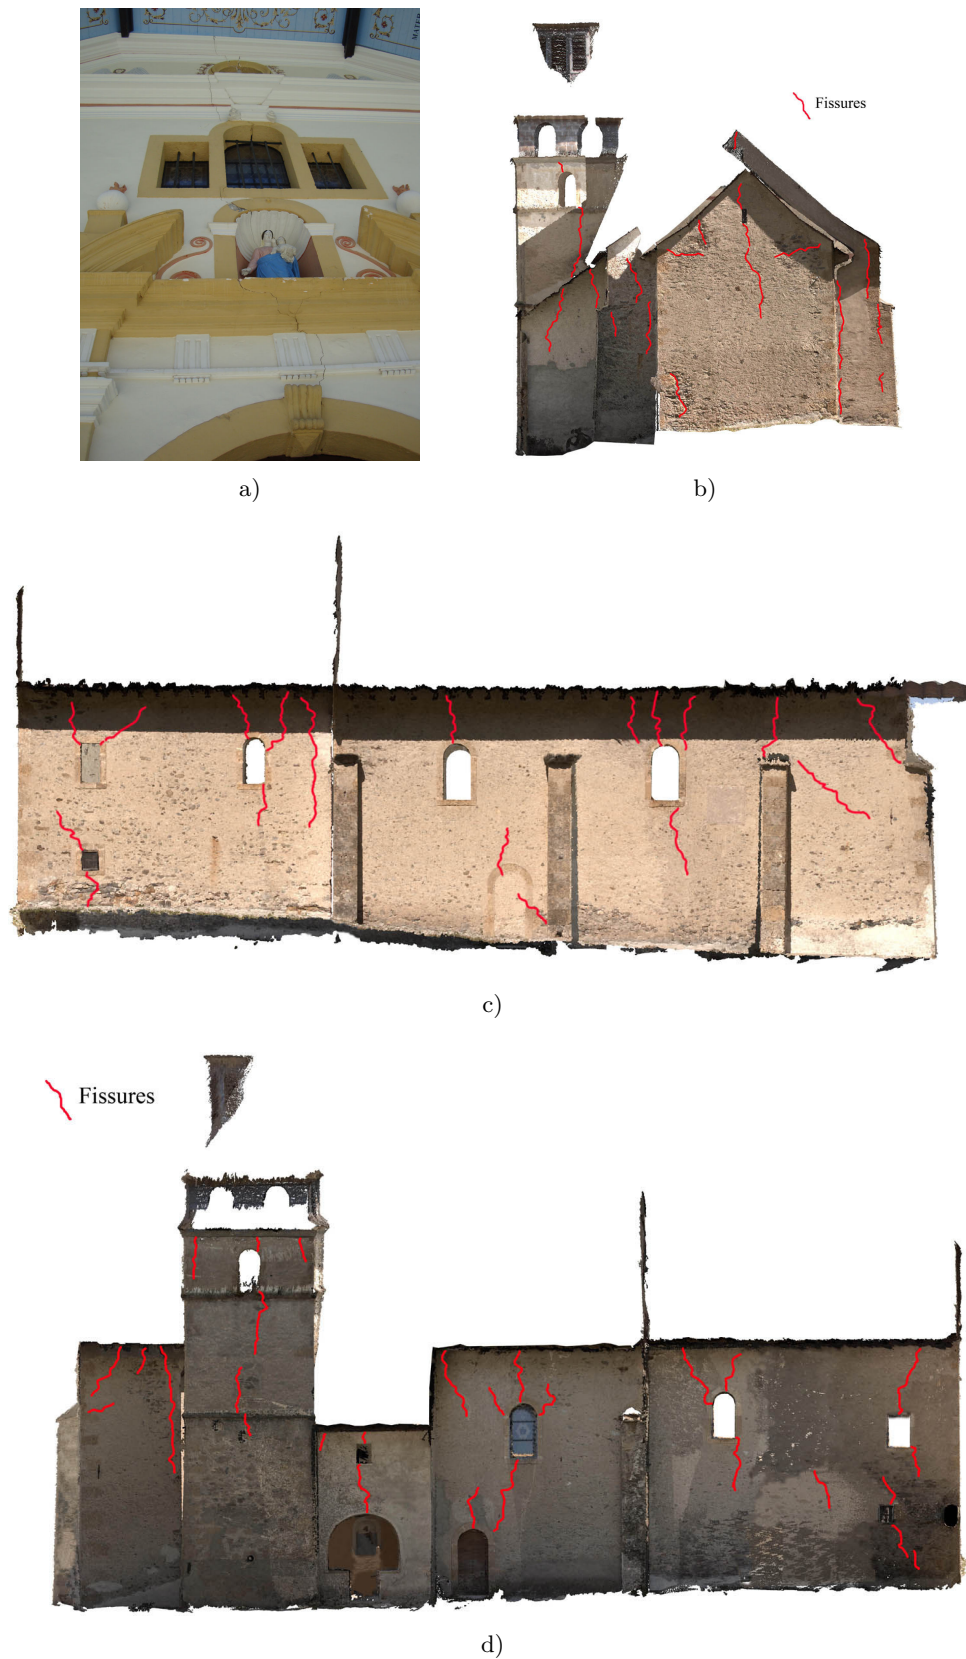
Relevé photogrammétrique des fissures de NDG. a) Élévation nord-ouest : fissures verticales à la jonction avec la nef, fissures horizontales dans le chevet à la hauteur des murs gouttereaux. b) Façade d'entrée : Photo de détail de la fissure verticale, traversante partiellement, toute hauteur. c) Façade latérale sud-ouest : fissures au droit des ouvertures, à la jonction nef/chœur et en tête de mur. d) Façade latérale nord-est : fissures à la jonction avec le clocher.
